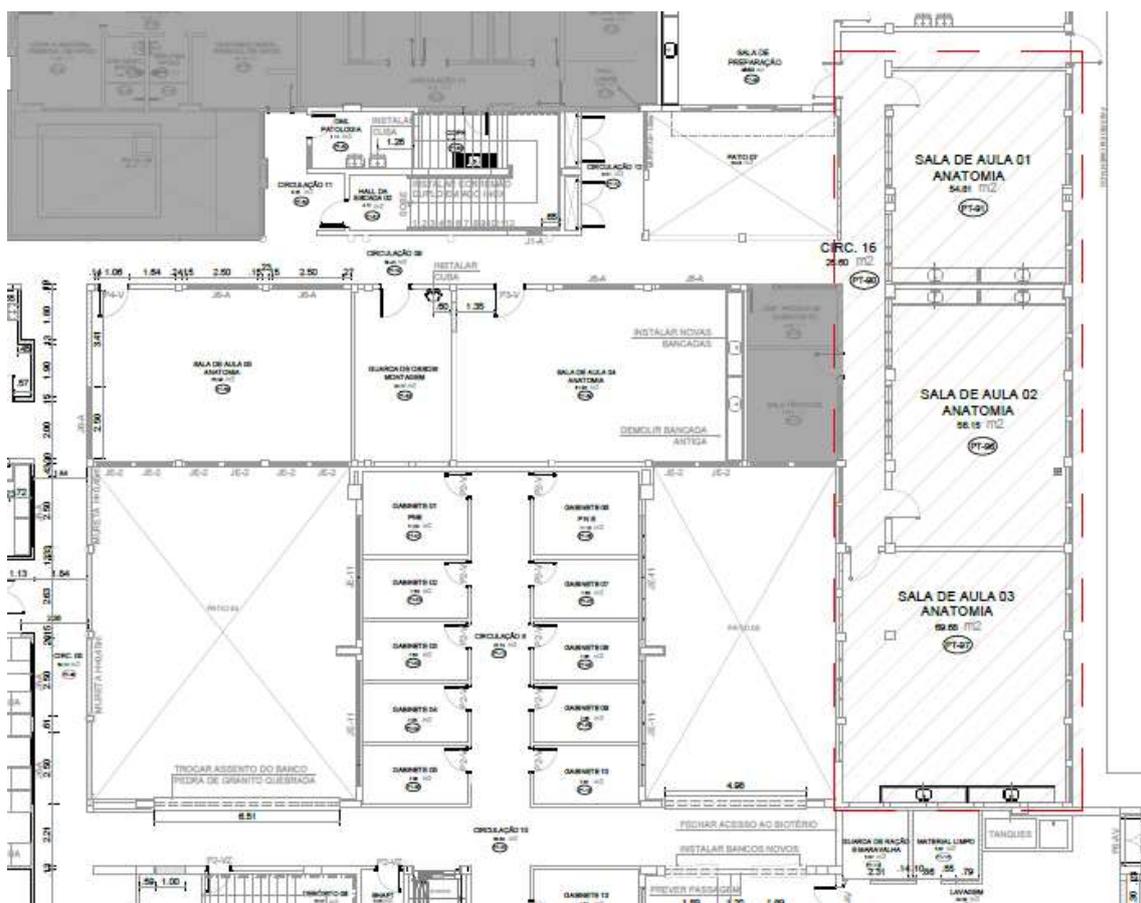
EMEVZ – Plata Baixa do Pavimento Térreo – Regiões de destaque no item 3.1;
